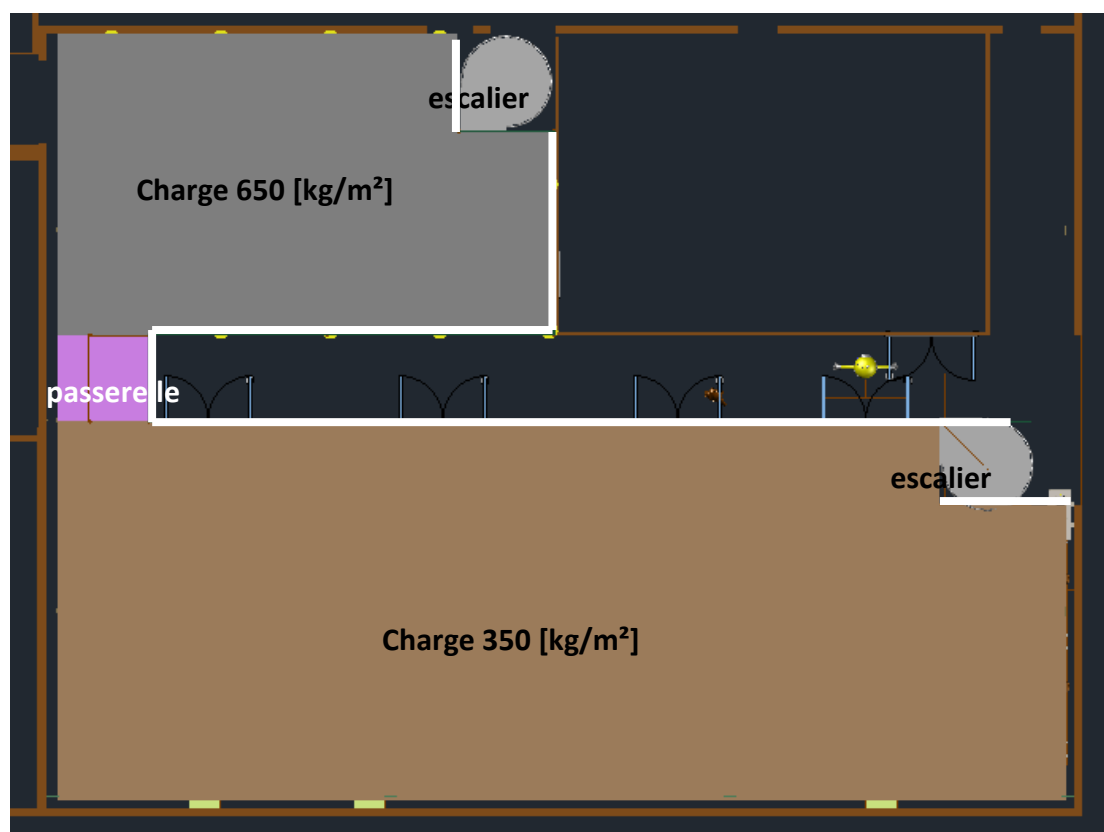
Vue de dessus des différentes zones de stockages et des accès. En blanc, la position des garde-corps.
